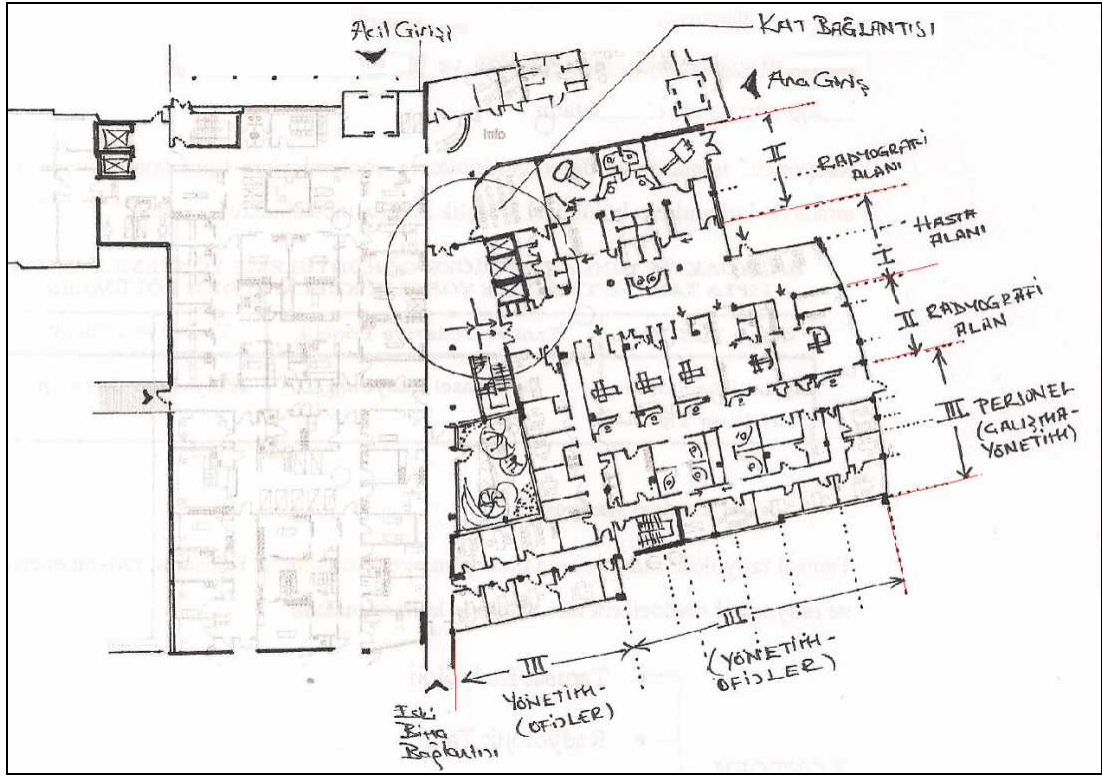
Vaziyet Planı, Kesit, Görünüş (yorum:D.Toğan)
